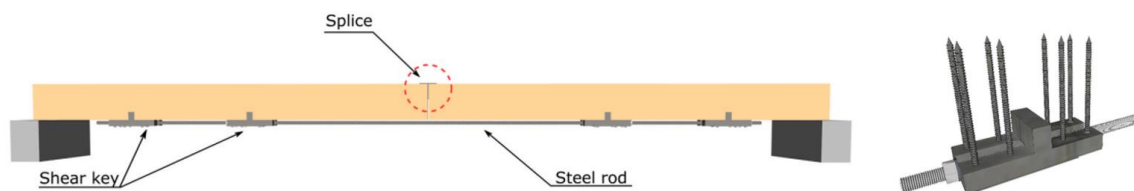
Esquema del sistema de varillas metálicas desarrollado por Wang et al. [23]
